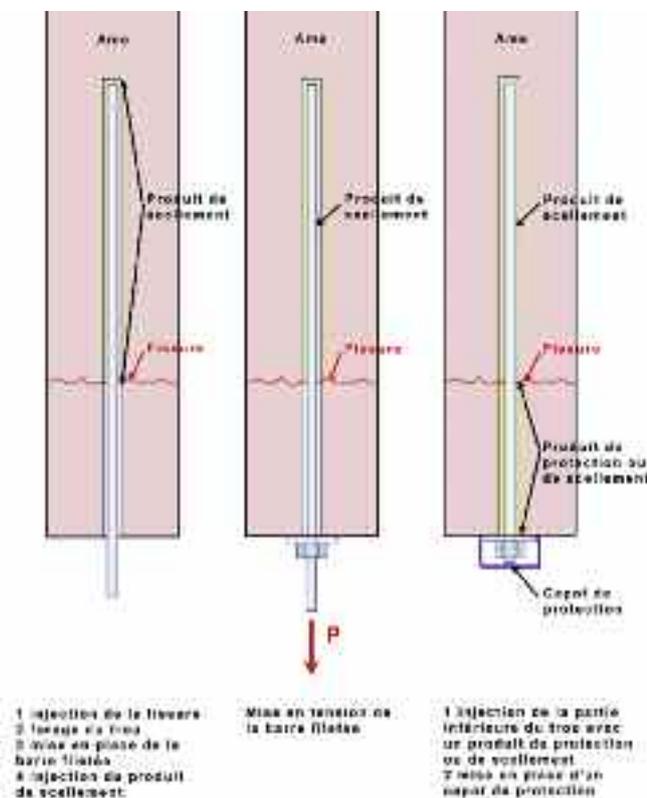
phases de réalisation d'une mise en précontrainte partielle de l'âme d'une poutre
